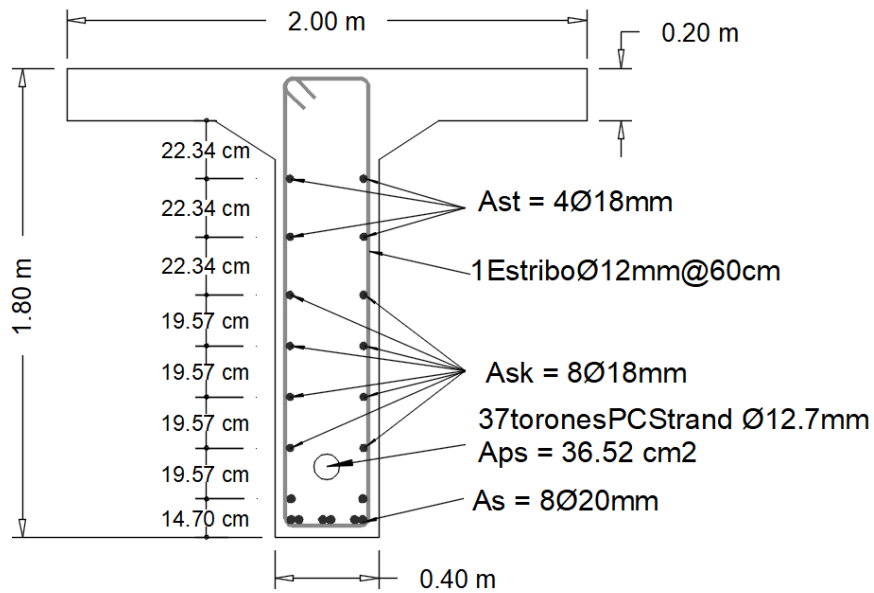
Sección de las vigas interiores en la variante de vigas de hormigón postensado
